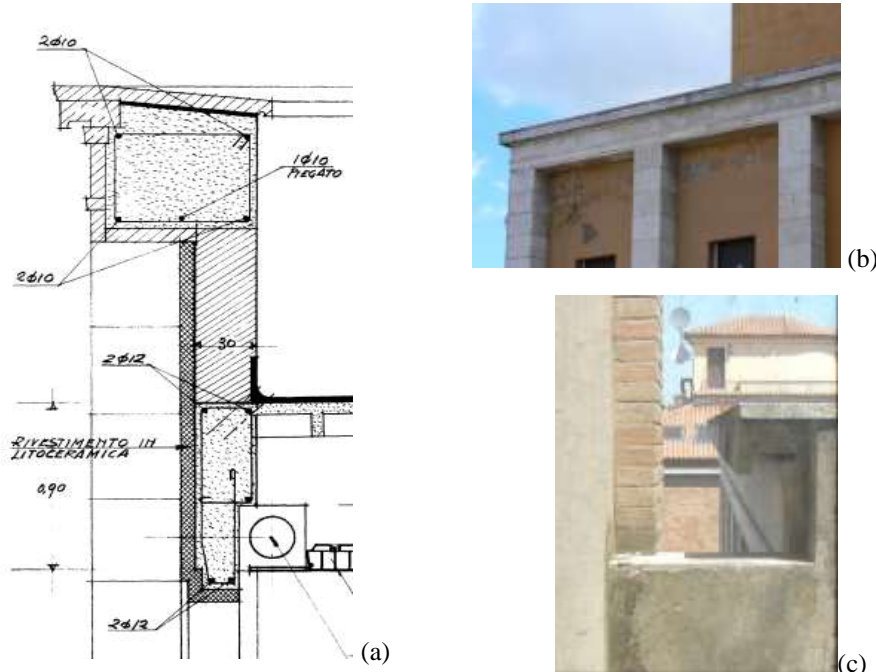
(a) Dettaglio del parapetto del quarto piano (come da progetto preliminare); vista del coronamento (b) dal prospetto principale su Piazza Caduti per la Libertà e (c) dalla torre su via Baccarini.
